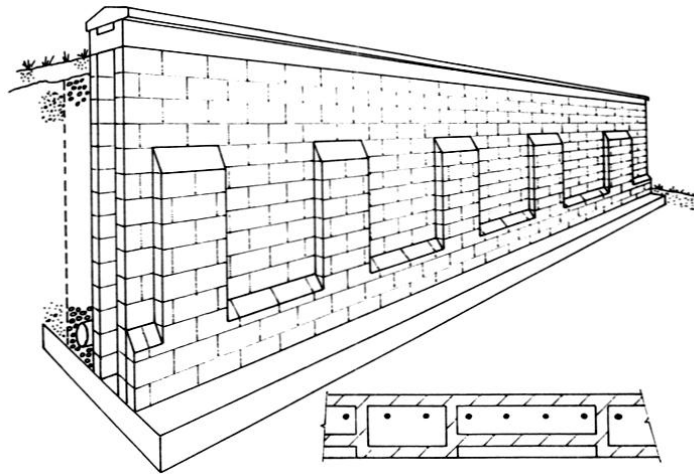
Вертикальное армирование опорных каменных стен [13]
